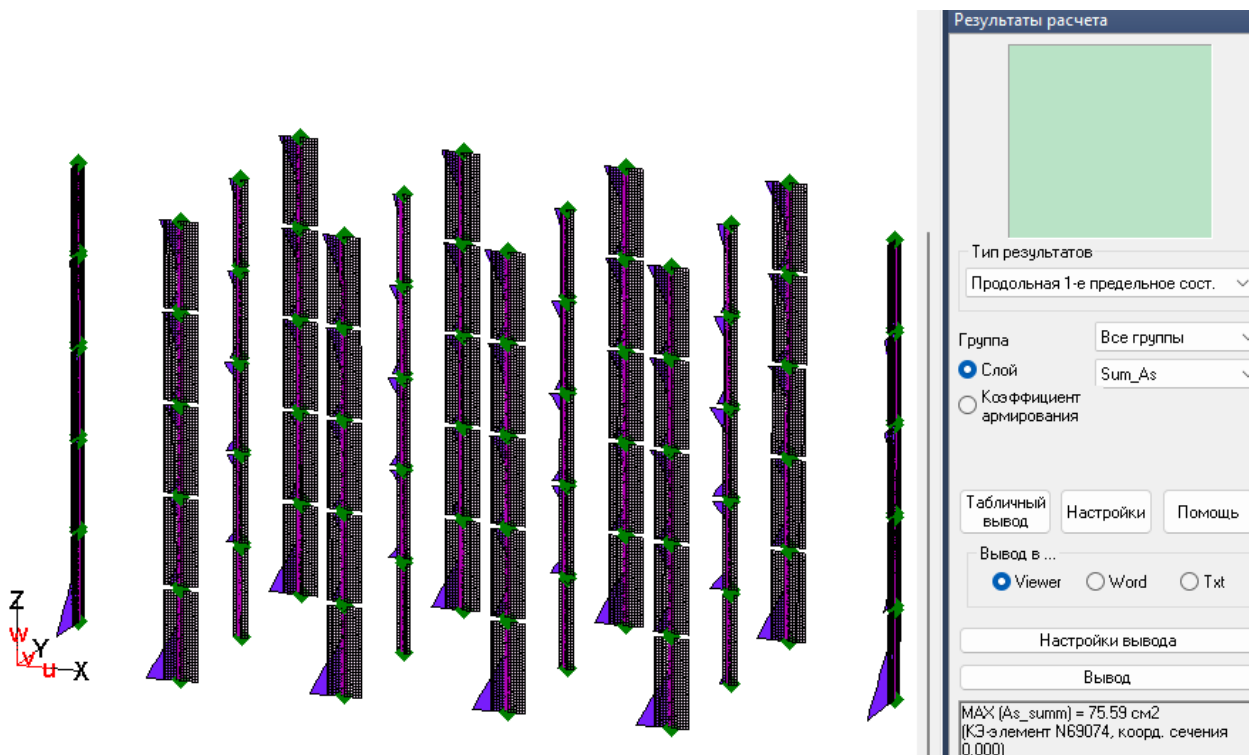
Эпюры арматуры в колоннах, кроме угловых (Схема с использованием оболочечных элементов стен по нормам СП).
